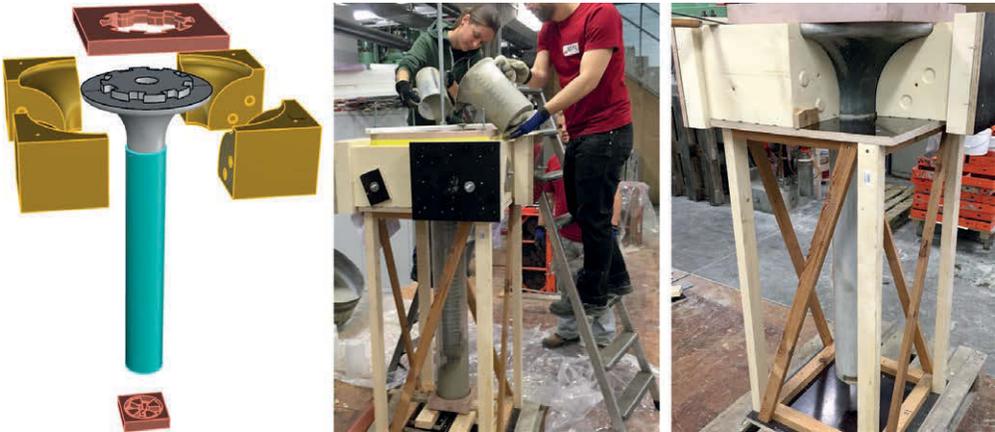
Schalungskonzept und Betonage der Stützelemente | Fig. 3: Formwork concept and concreting of column elements | Source: Jeldrik Mainka
